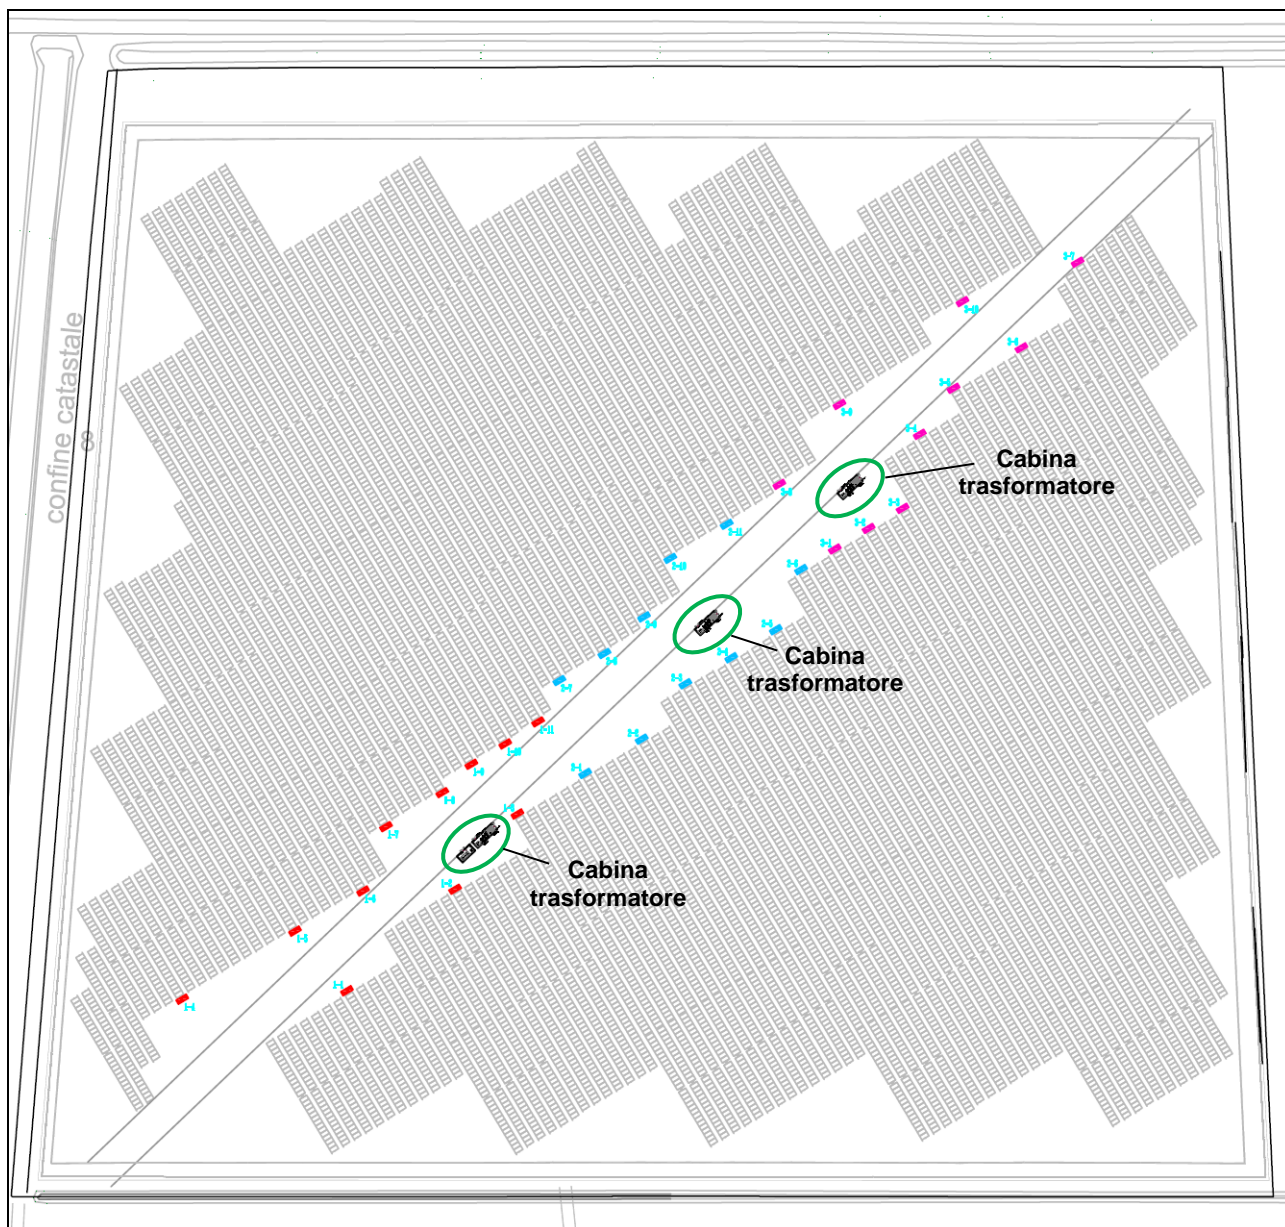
Planimetria del campo fotovoltaico con individuazione delle sorgenti sonore
